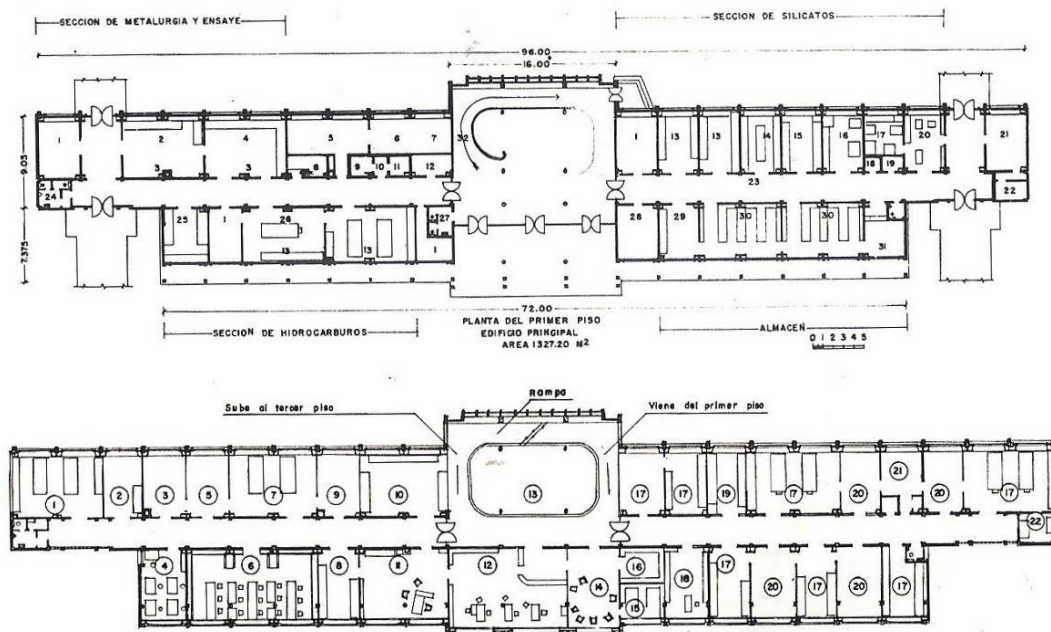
Erd- und Obergeschoss des Hauptgebäudes aus dem Jahr 1941. In der Eingangshalle befand sich eine Rampe, die wegen Geldmangel durch eine Treppe ersetzt wurde.
